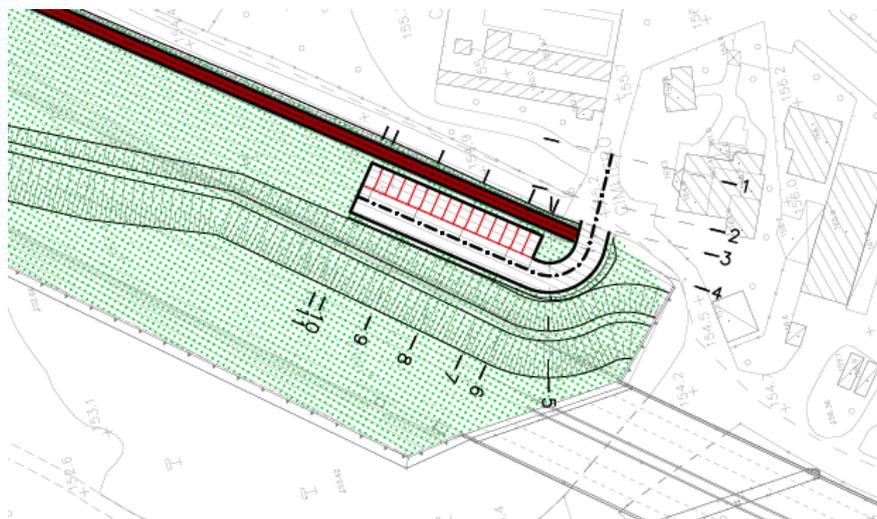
Stralcio planimetrico accesso al parcheggio P2
